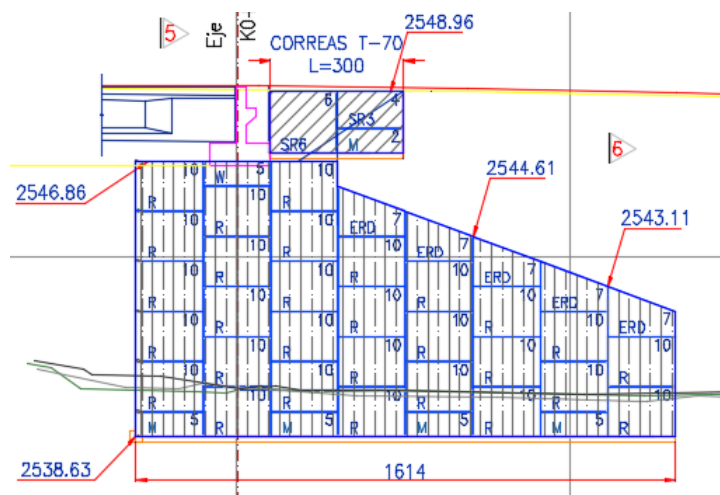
Detalle viga solera. (Stup Latinoamérica)
